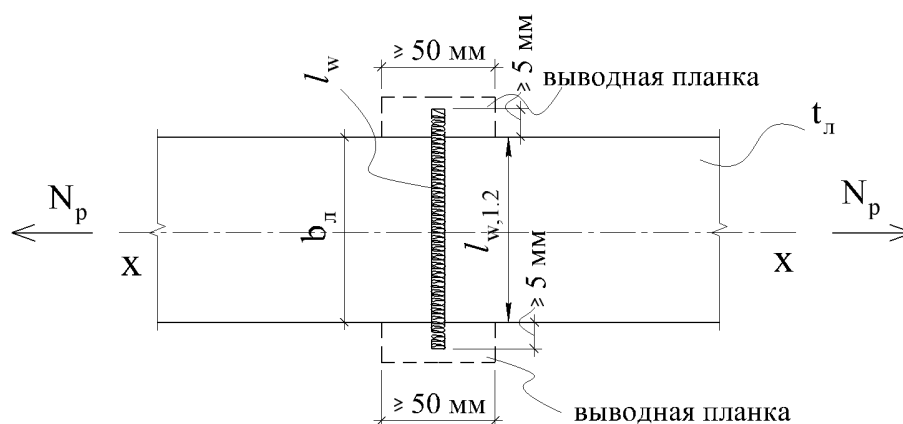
Схема сварного стыка двух листов, нагруженных центрально приложенной силой растяжения
